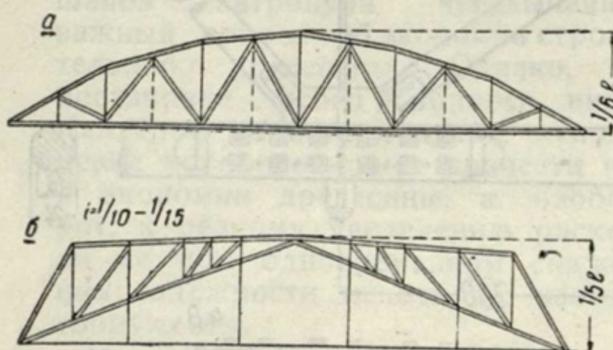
а) Полигональная деревянная ферма из бревен со стойками из круглого железа; б) деревянная ферма для бесчердачного перекрытия с металлическими стойками и затяжкой.
